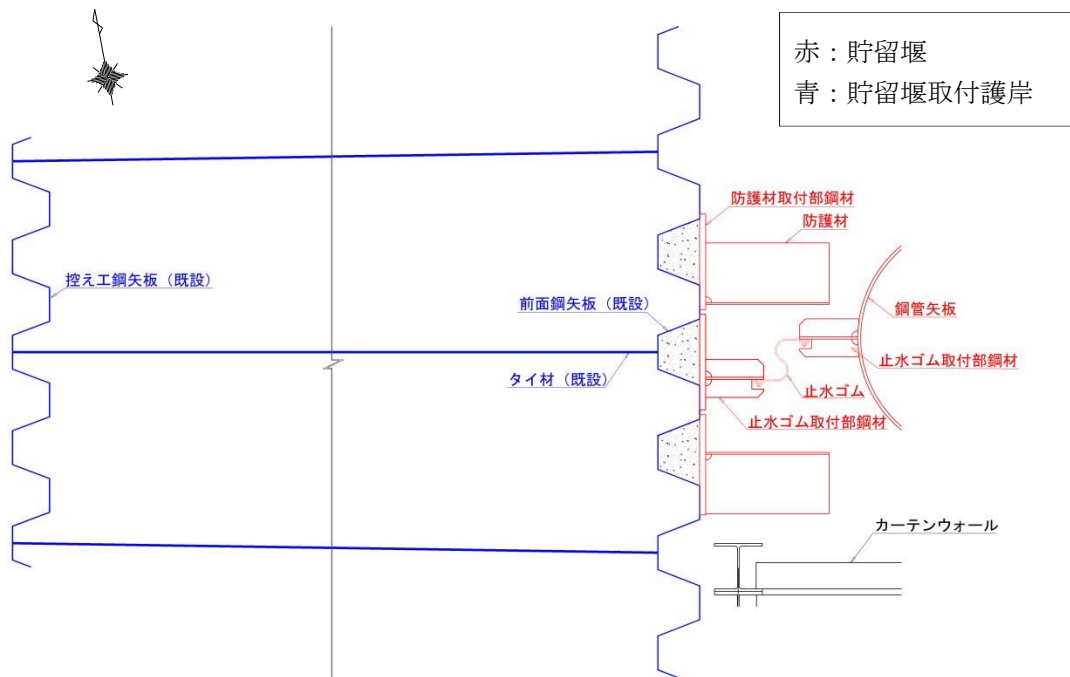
(2) 貯留堰の平面図 (A 部拡大)
